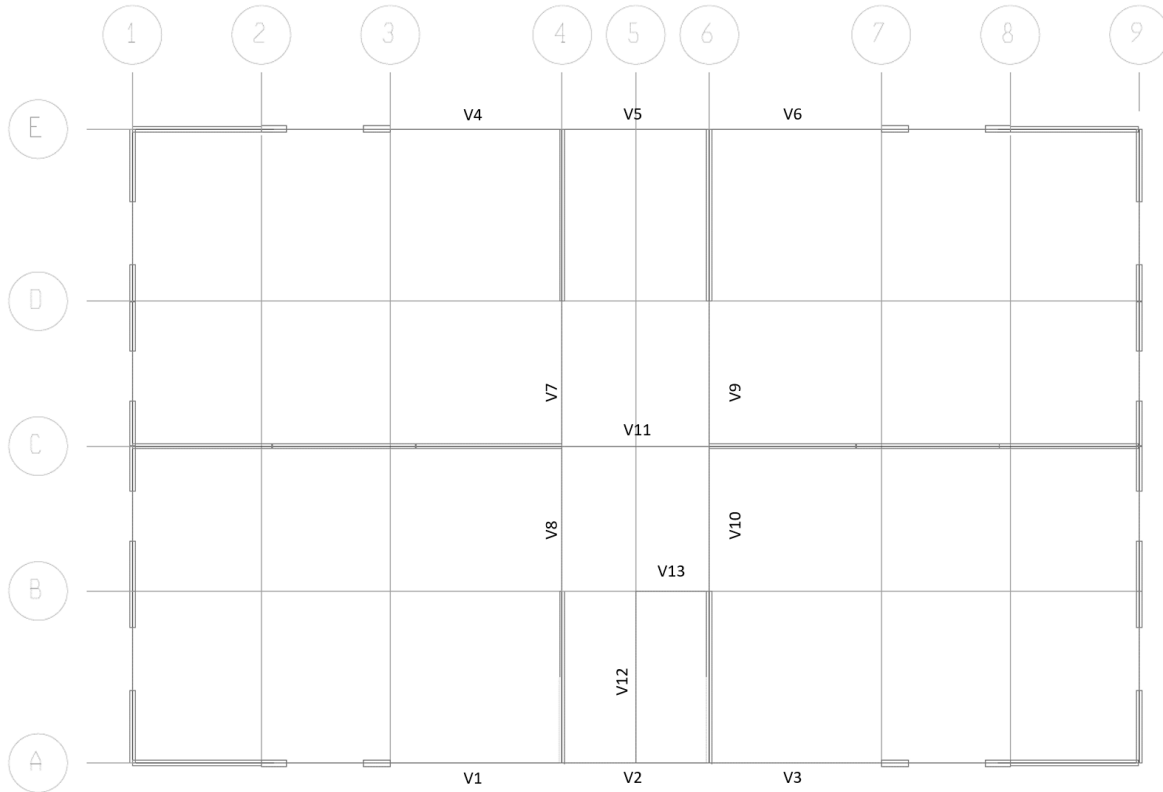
Planta de piso identificando las vigas a diseñar.
